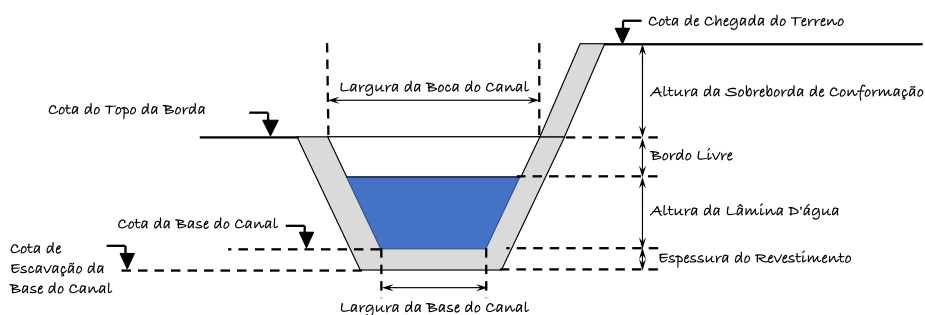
Desenho esquemático da geometria e cotas do sistema de canais/canaletas
